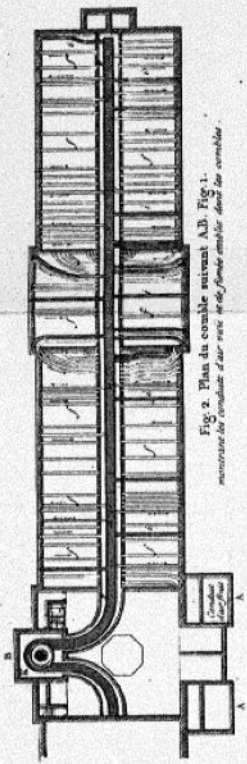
Plan du comble suivant A.B. Fig. 1. montre les conduits d'air avec les fondes amblés dans les arêtes.
